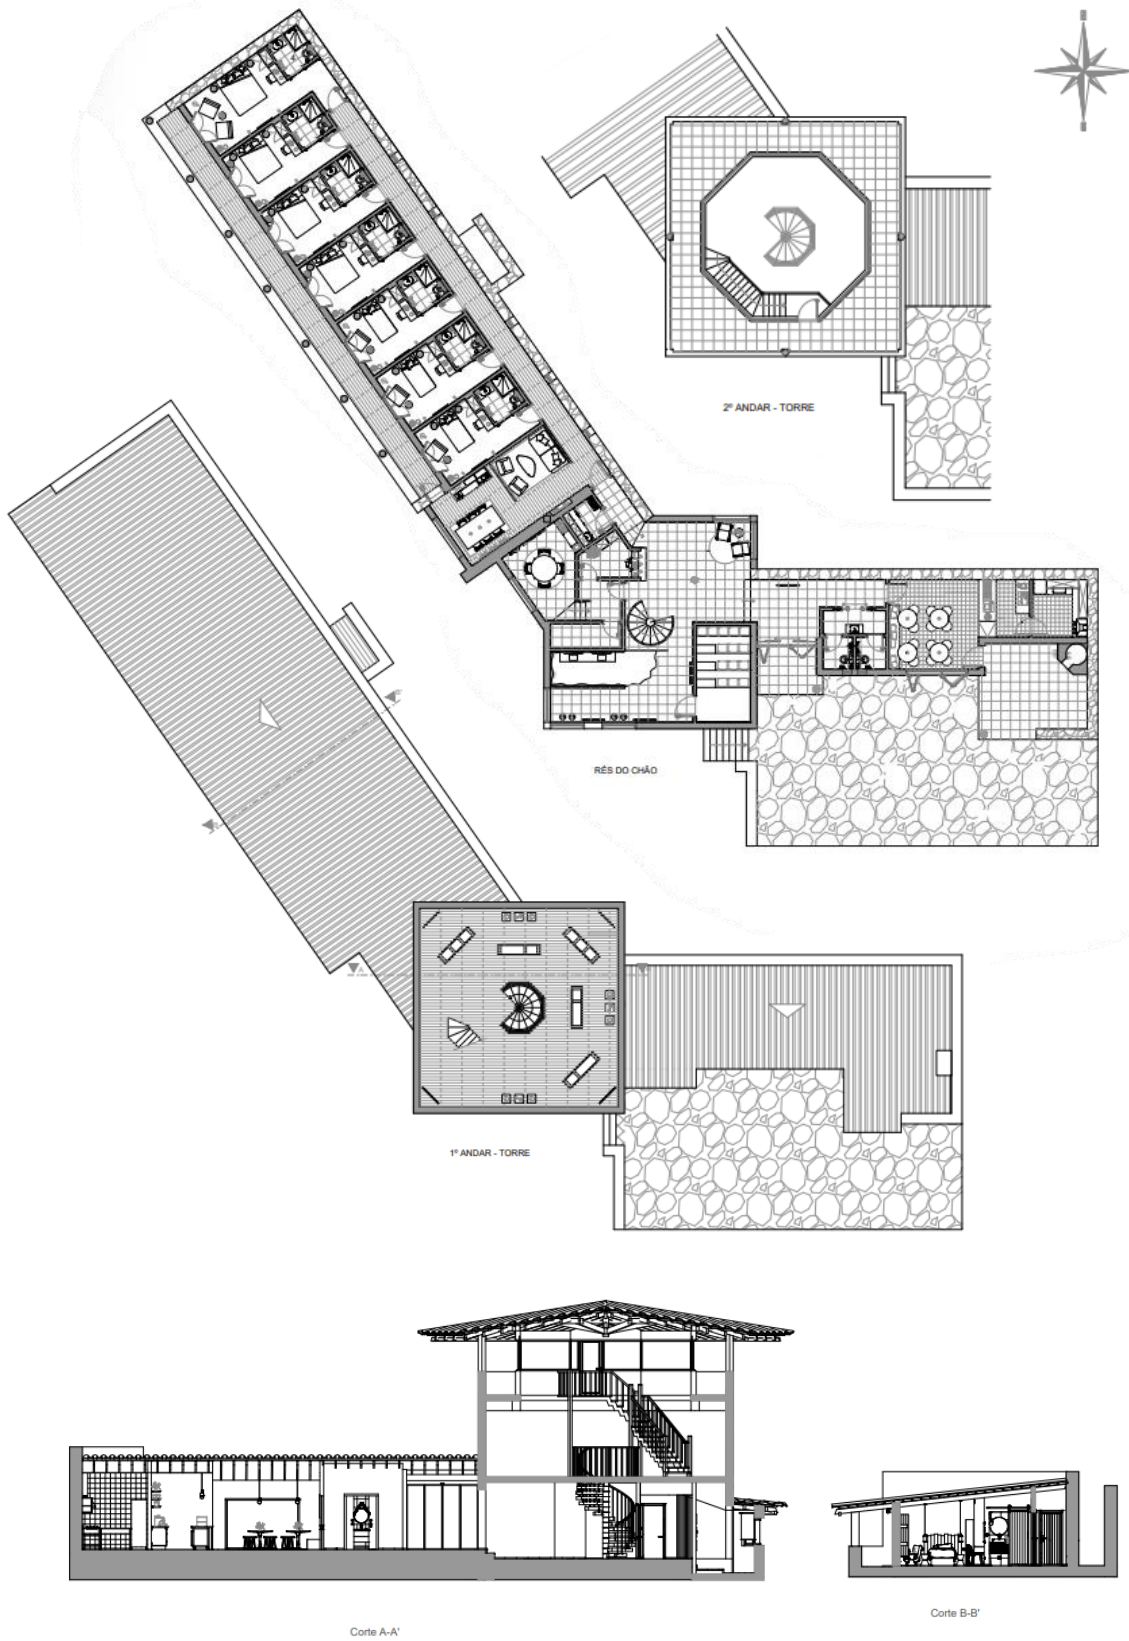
Planta de Apresentação e Cortes. Fonte: Autor.
